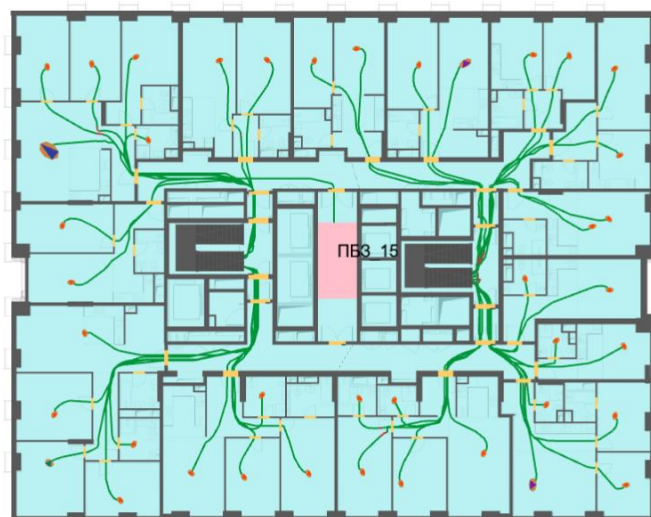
План 15-го – 31-го этажа и нанесенная на него расчетная (принципиальная) схема эвакуации
